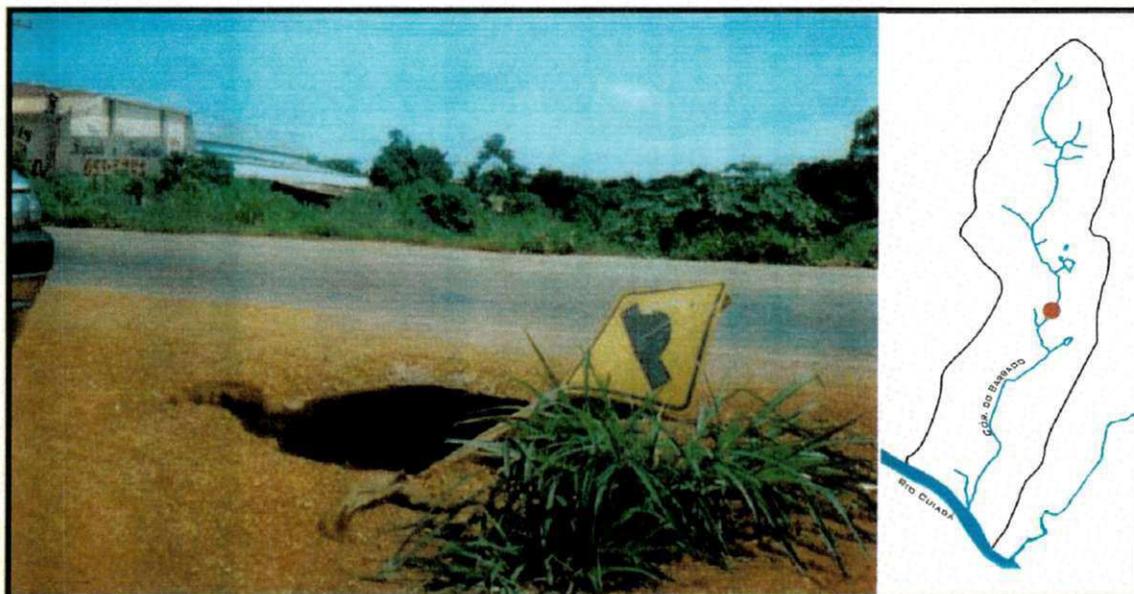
Danificação de pavimento viário da Avenida Arquimedes Pereira Lima
